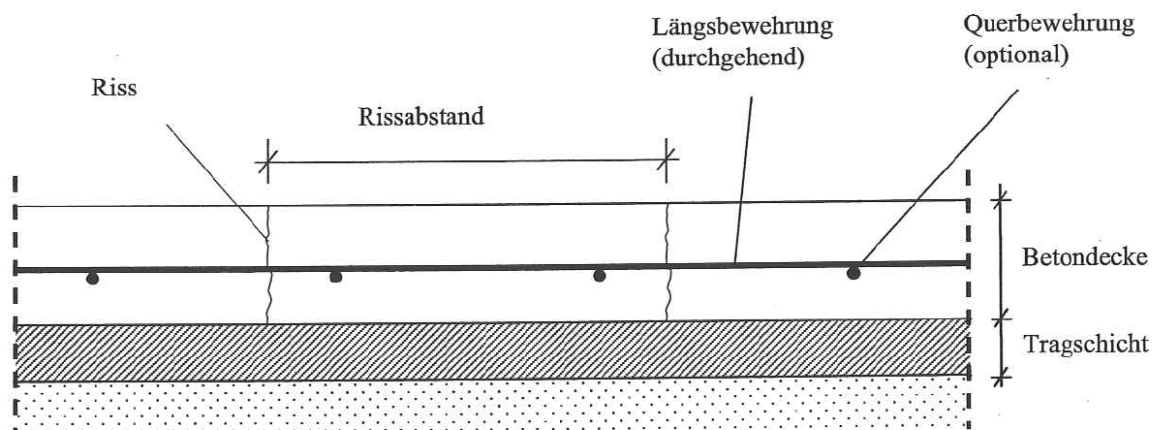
Prinzipskizze einer durchgehend bewehrten Betondecke [57]
